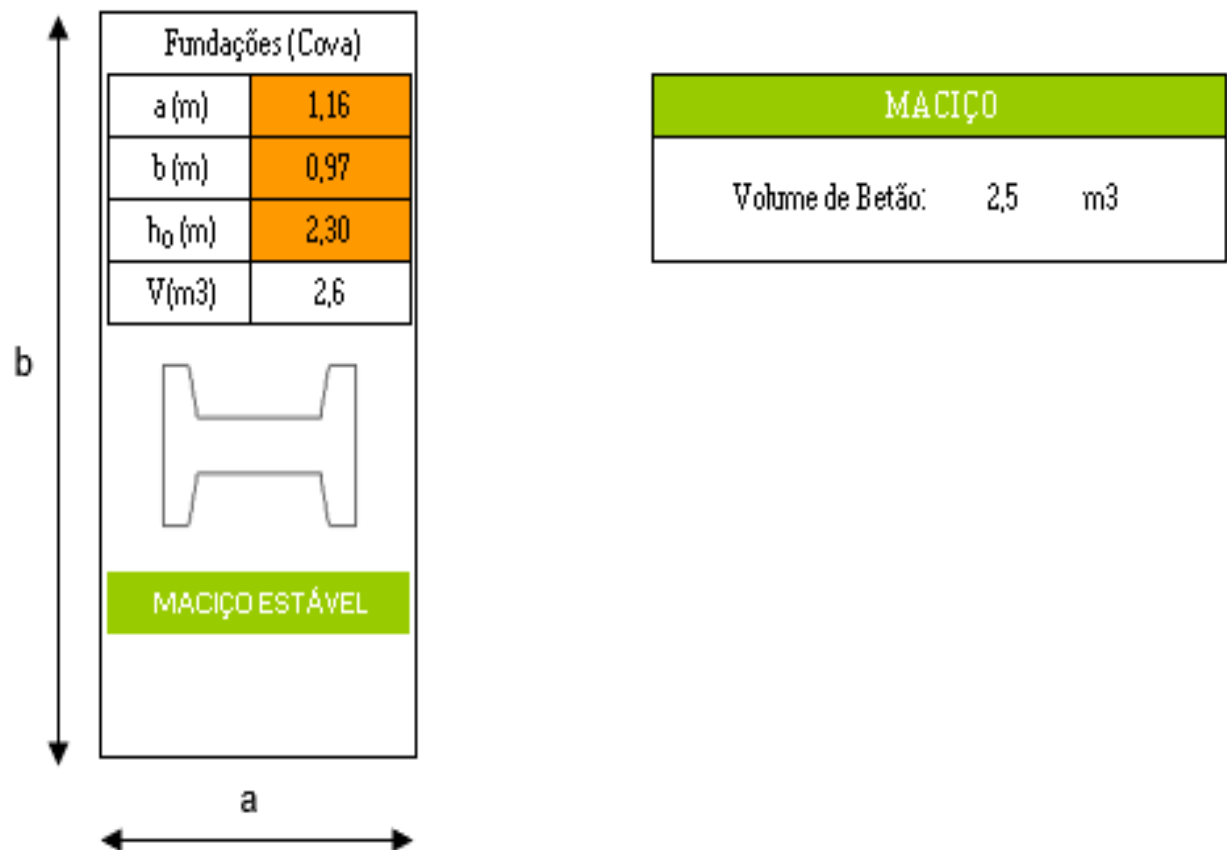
Fundações de apoio 1600/540 14 [17].
